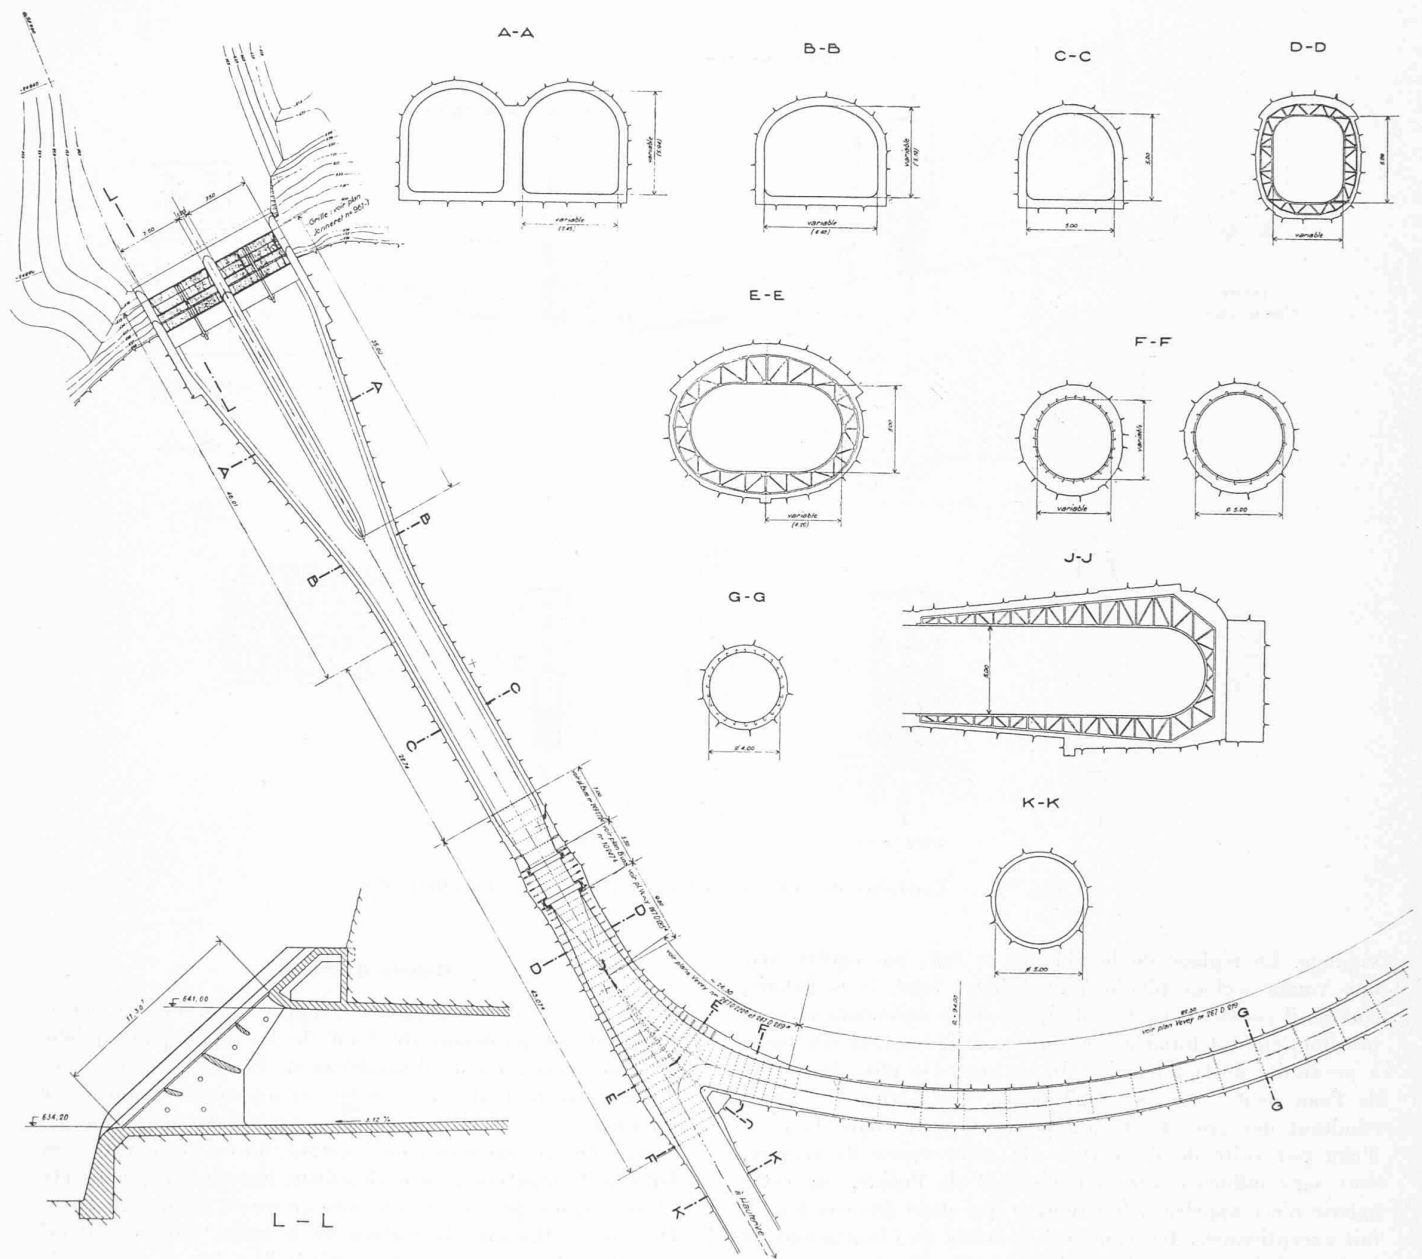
Plan et coupes de la prise d'eau et de la galerie de vidange. Echelle 1 : 800 et 1 : 400.
